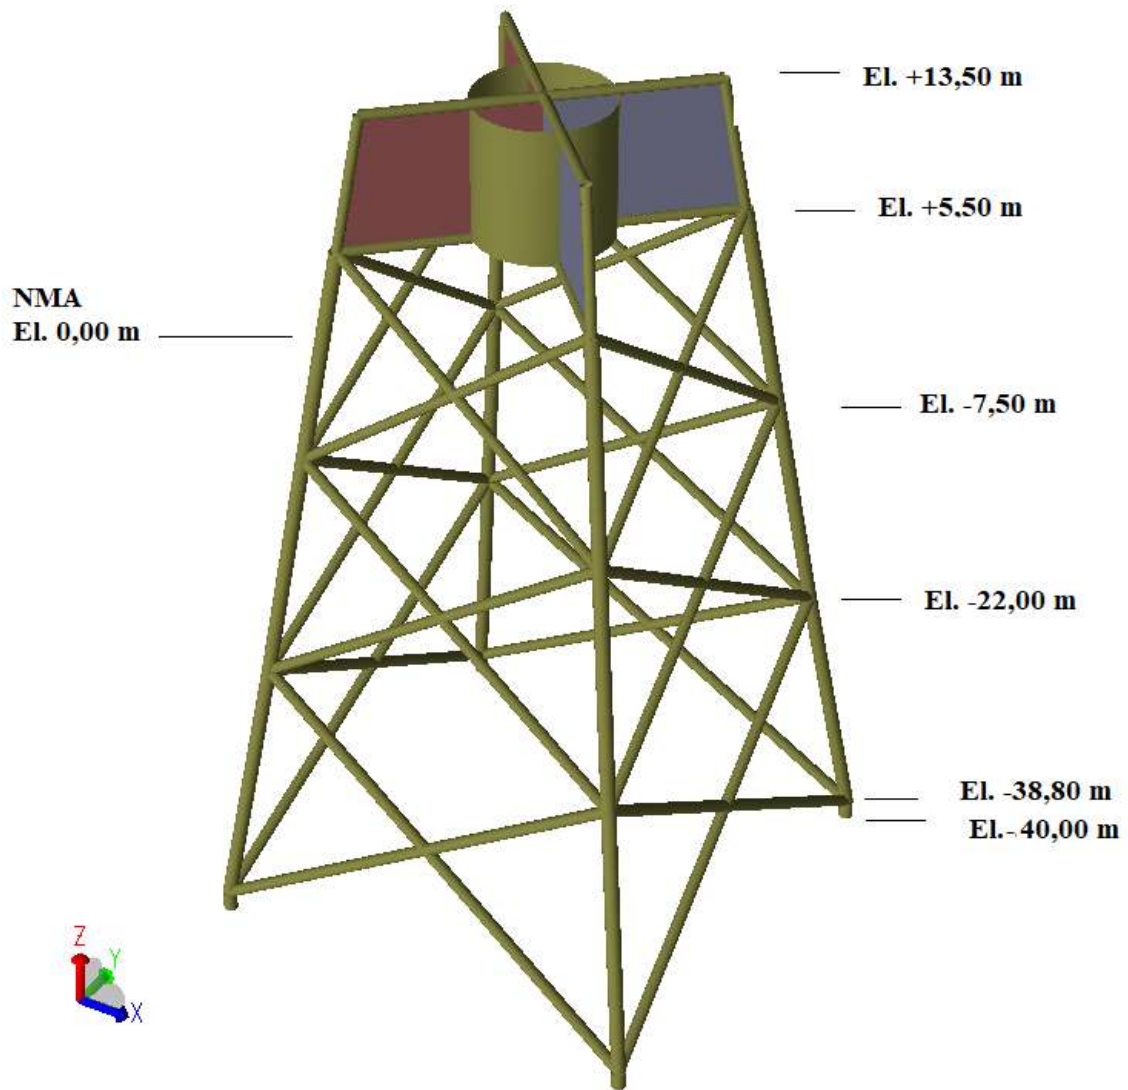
Modelo estrutural da jaqueta com elevações.
